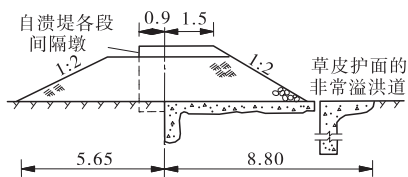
漫顶自溃式非常溢洪道 (单位:m)
